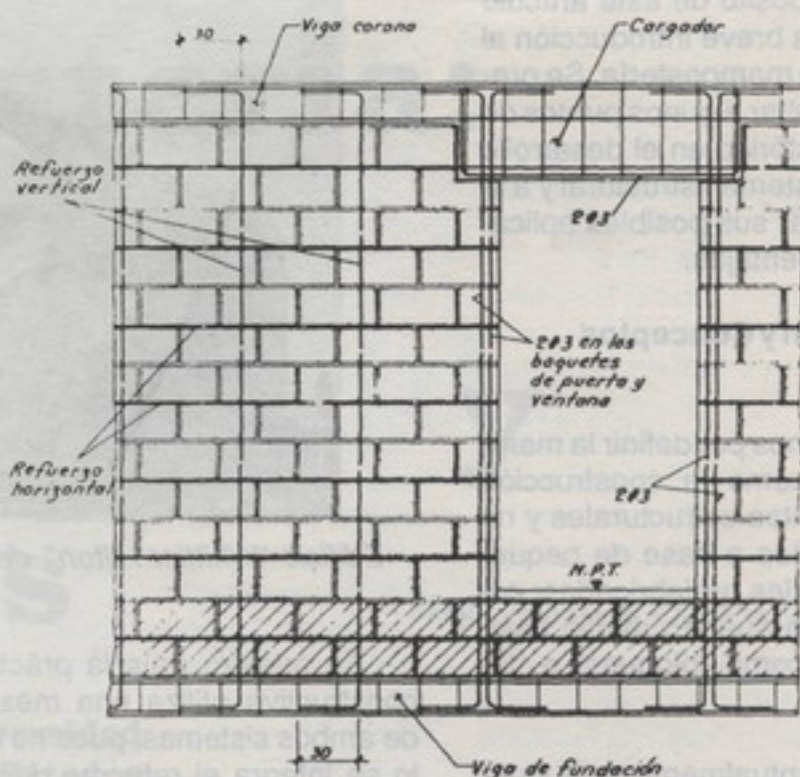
Elevación típica de pared mampostería con refuerzo integral.
